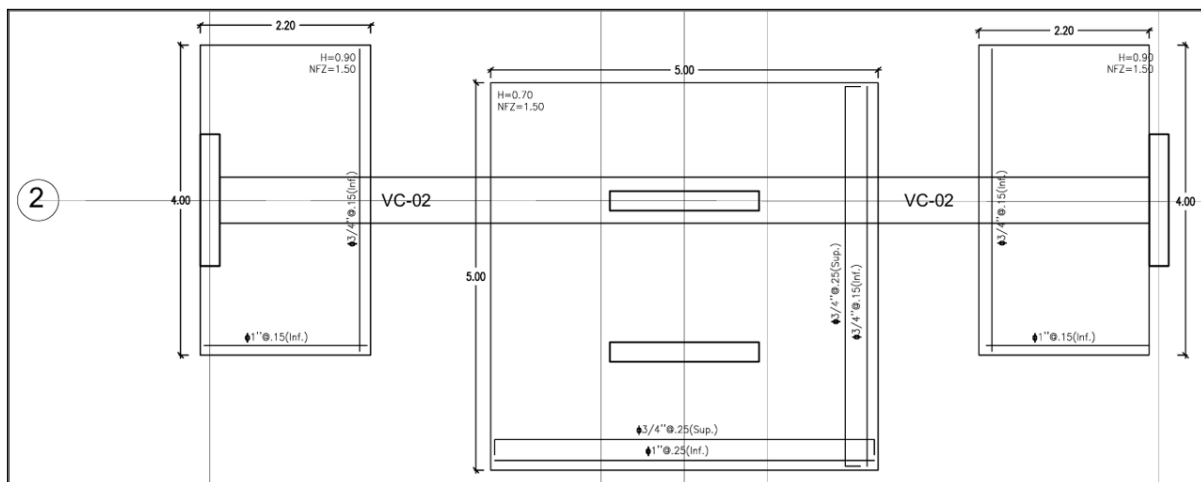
Esquema final en planta de la zapata conectada VC-02.
